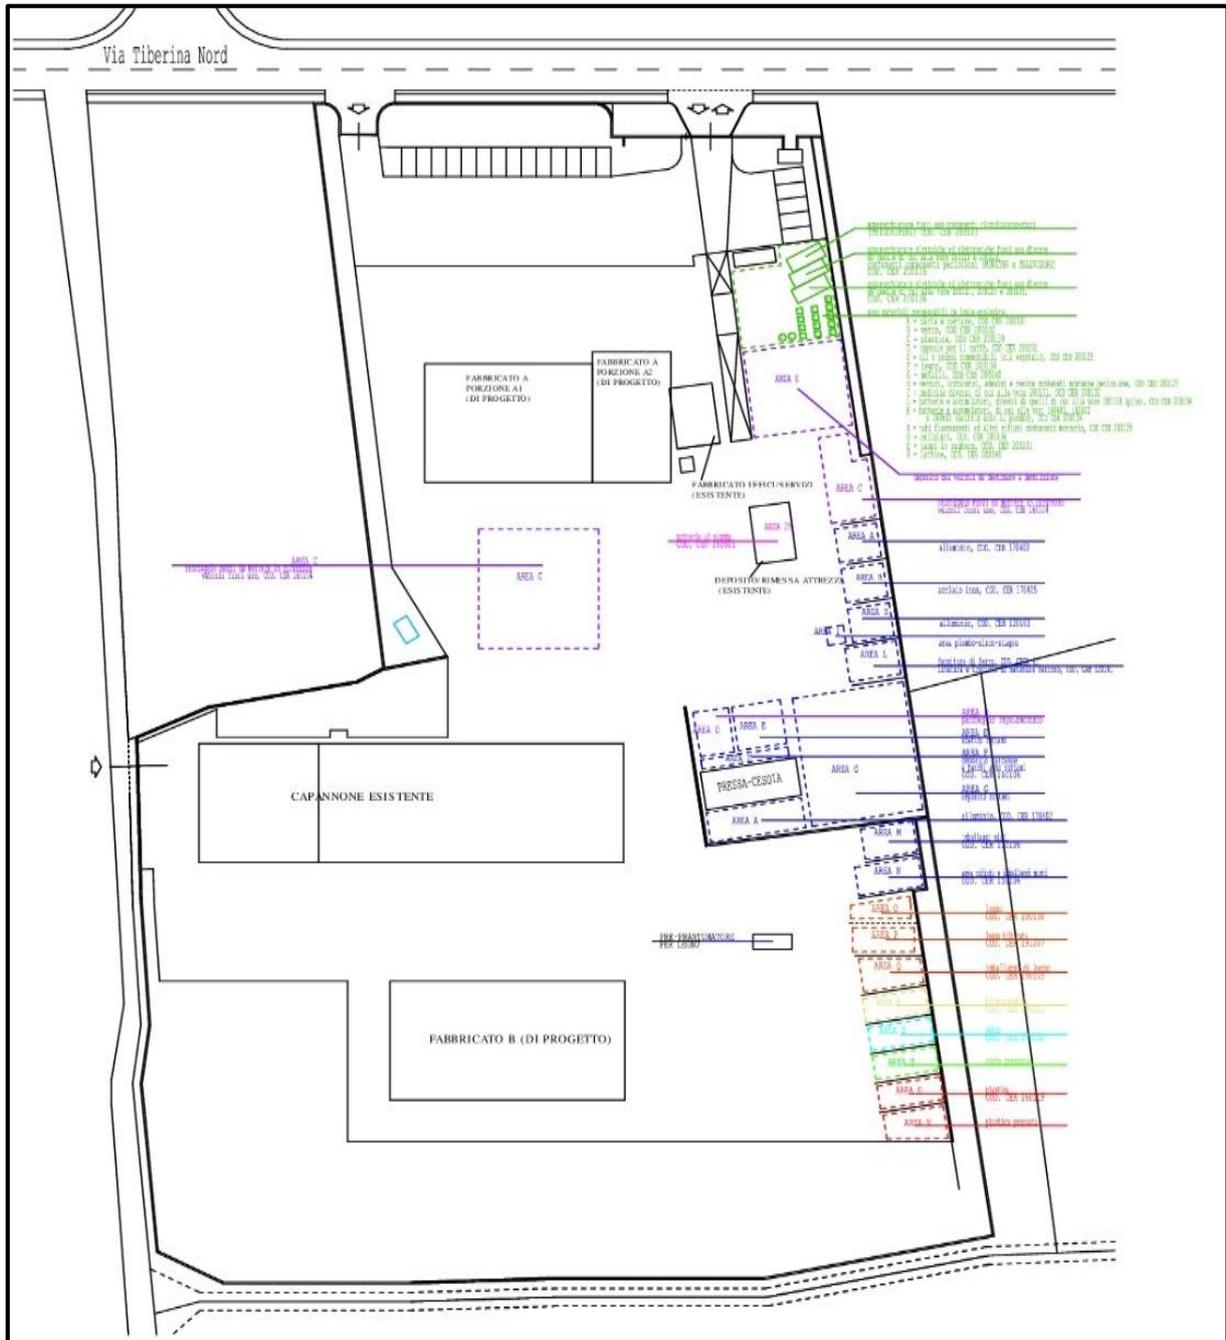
Planimetria generale stato di progetto con dettaglio aree di stoccaggio esterne(Tav. A1)
